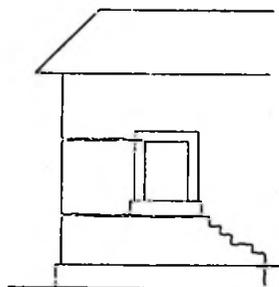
Fissuras horizontais produzidas por uma forte anisotropia das paredes, no caso de recalque de uma esquina.
